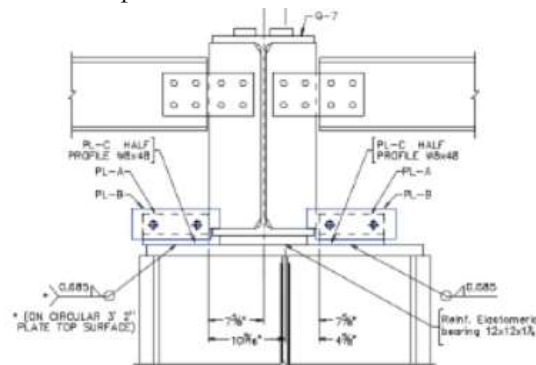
Detalle de elemento de apoyo en la cabeza de los pilotes de la plataforma (enchufes).
